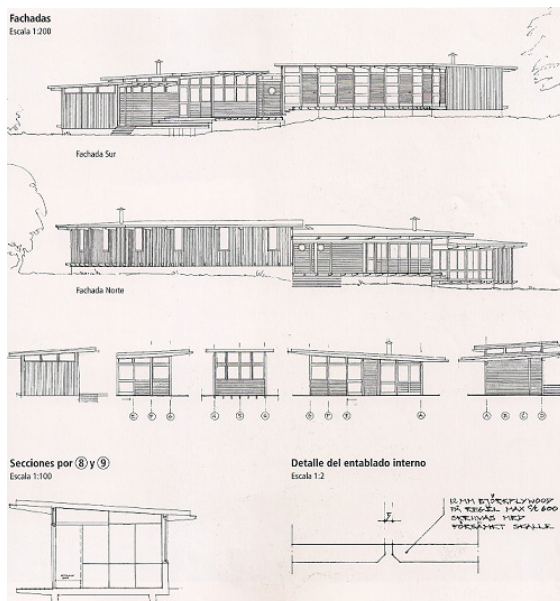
Plano en planta de las fachadas a escala 1 : 200
